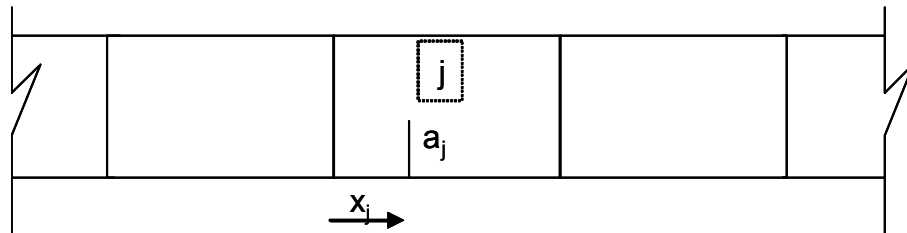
Posição (x_j) e tamanho (α_j) da fissura no elemento j da viga.
